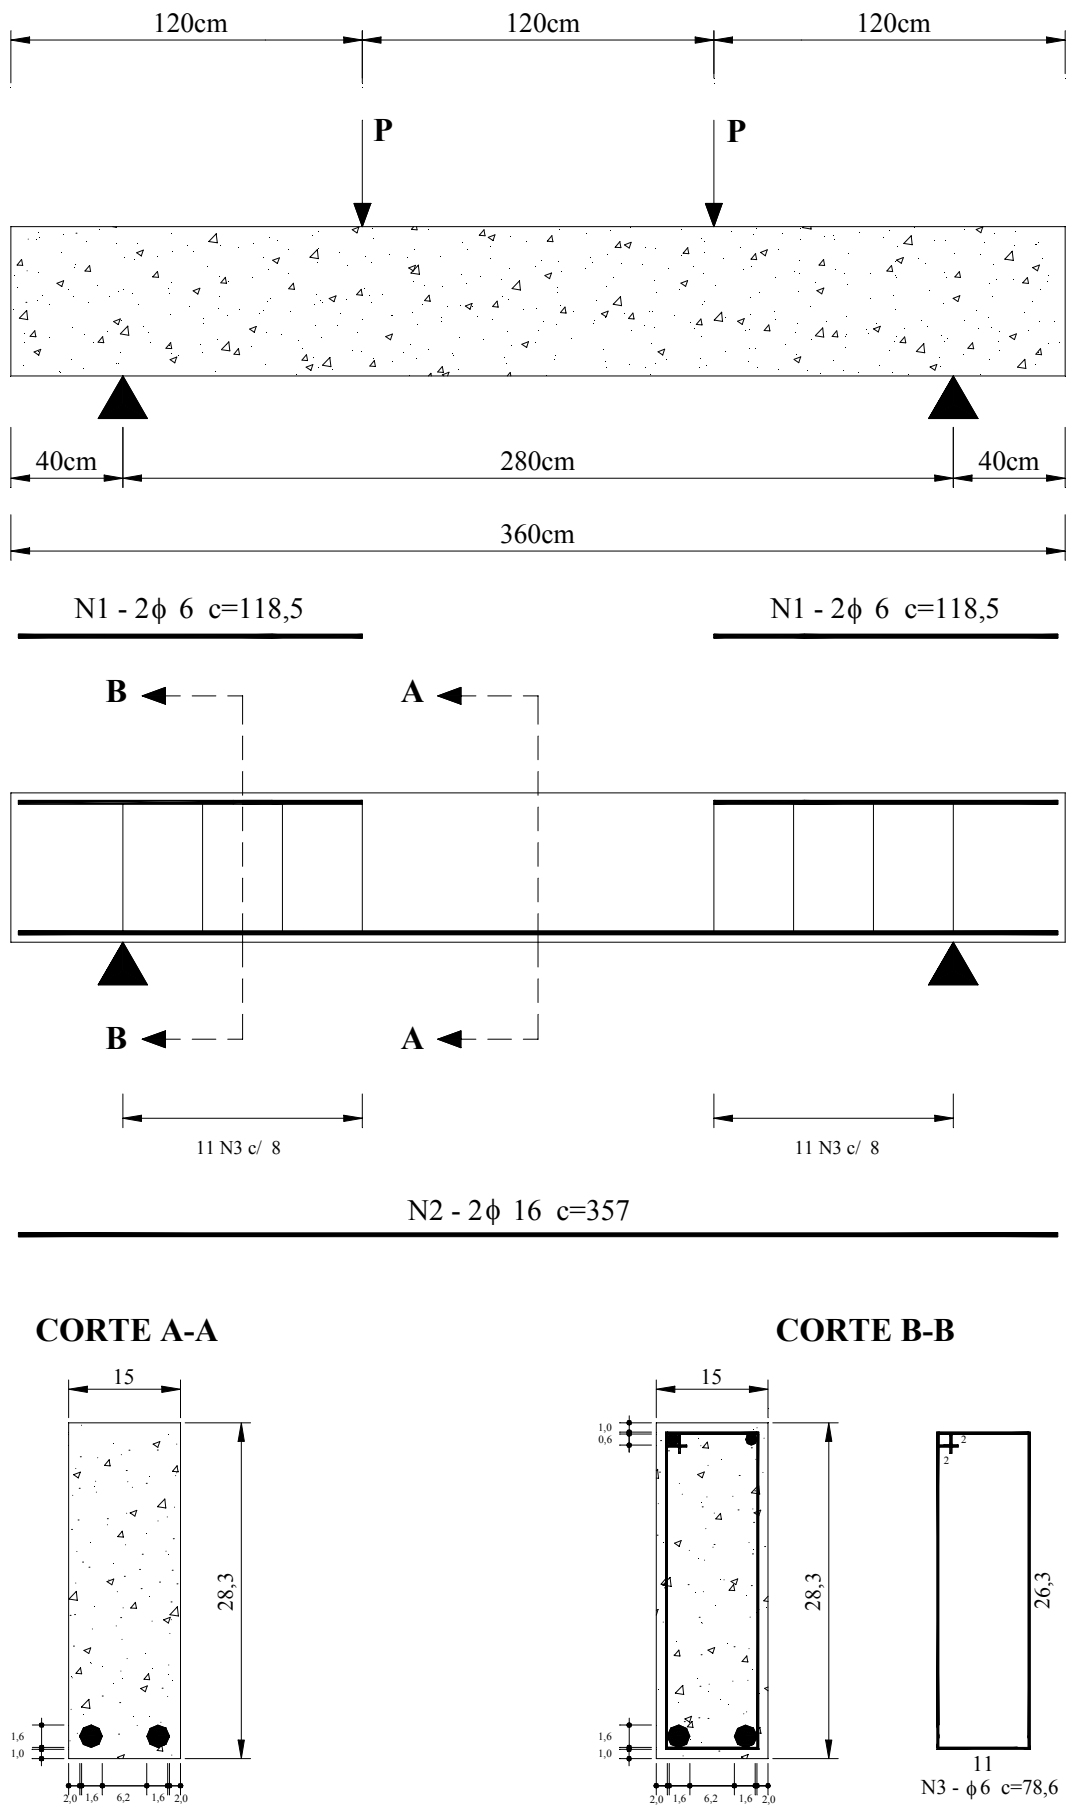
Detalhamento da viga ensaiada por Barbosa (1998)
